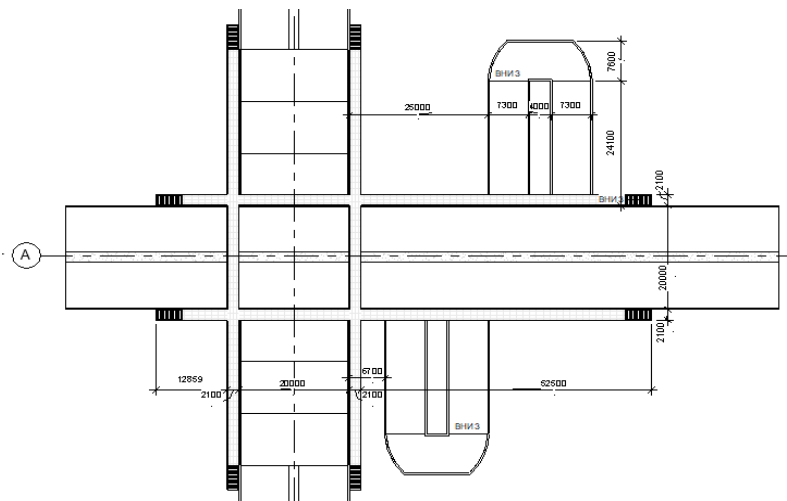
архитектурно-планировочное решение (план площадки)
